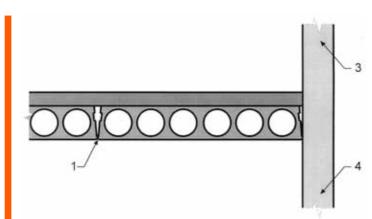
Dalles de 20 cm d'épaisseur avec une chape de 8 cm parallèles à la façade en béton armé de 18 cm d'épaisseur
